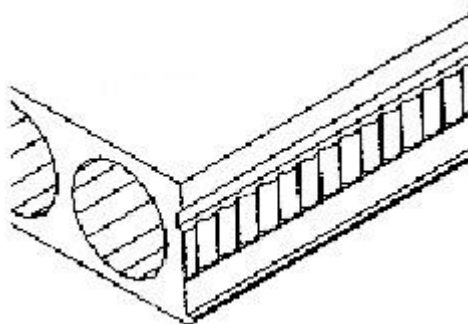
Junta ondulada de lajes alveolares [20].
